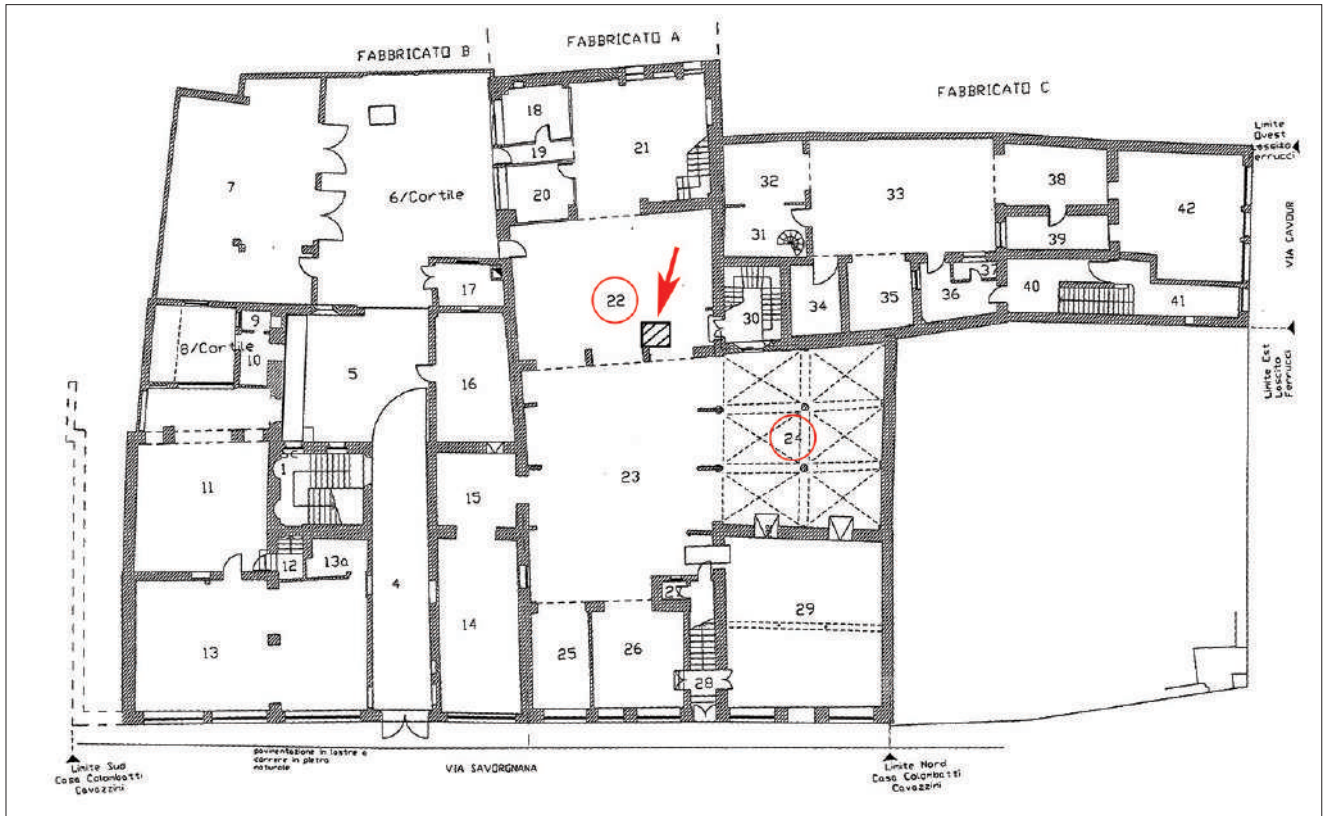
Planimetria del piano terra di Casa Colombatti Cavazzini con la localizzazione dell'area di rinvenimento.
